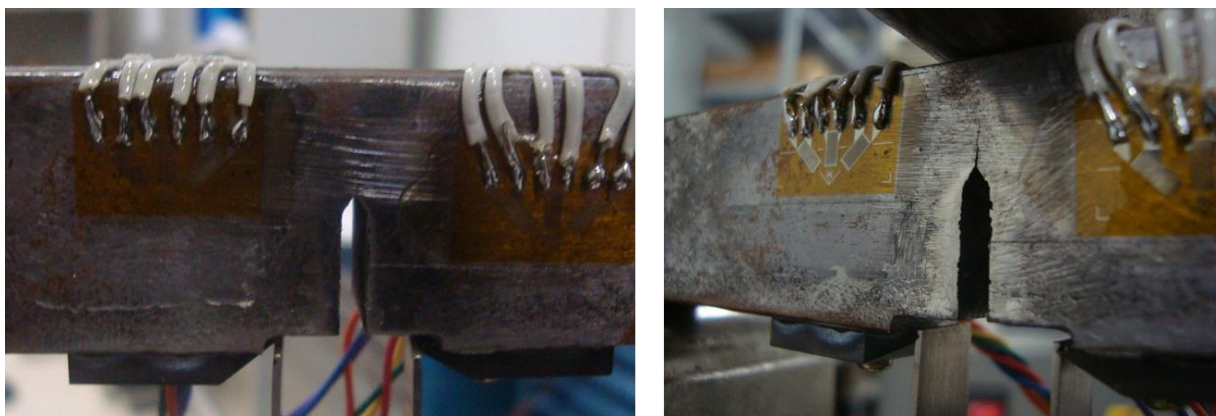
Viga  $CT'$  com pré-trinca e viga  $CT'$  no final do ensaio de fadiga.
